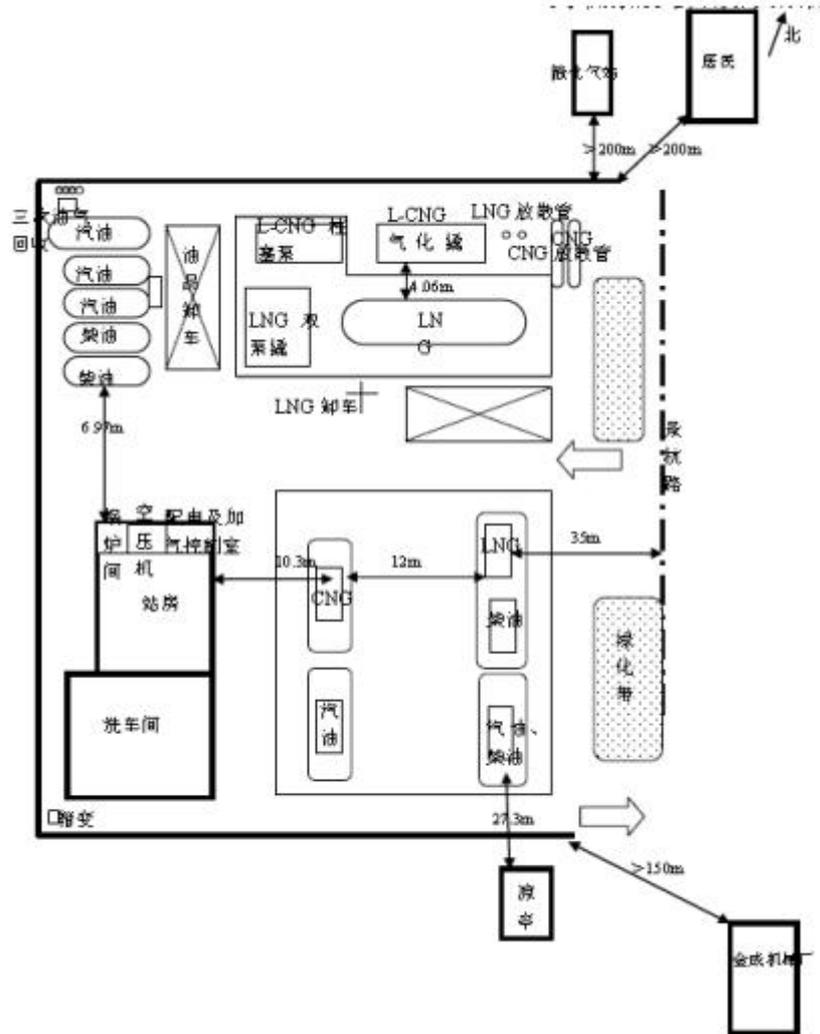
景杭路加油加气站平面布置及周边环境图
